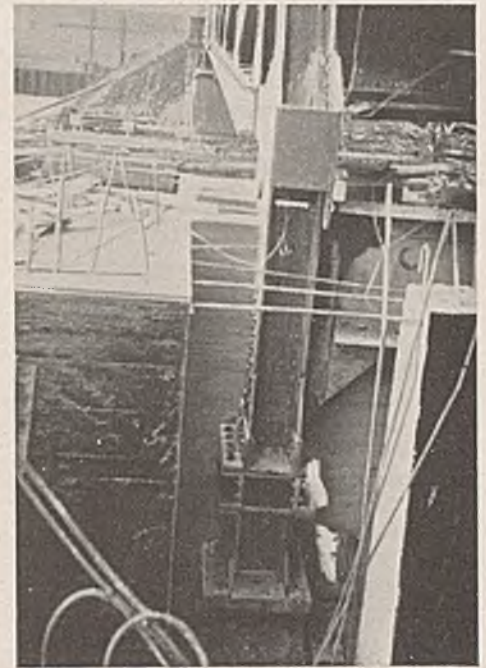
Schlitz im Beton des rechten Widerlagers für die Pendelkonstruktion.
